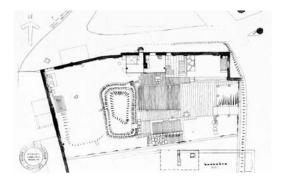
Planta del conjunto con el nuevo pabellón integrado con las preexistencias de la parcela (Krucker 2002, 28)
